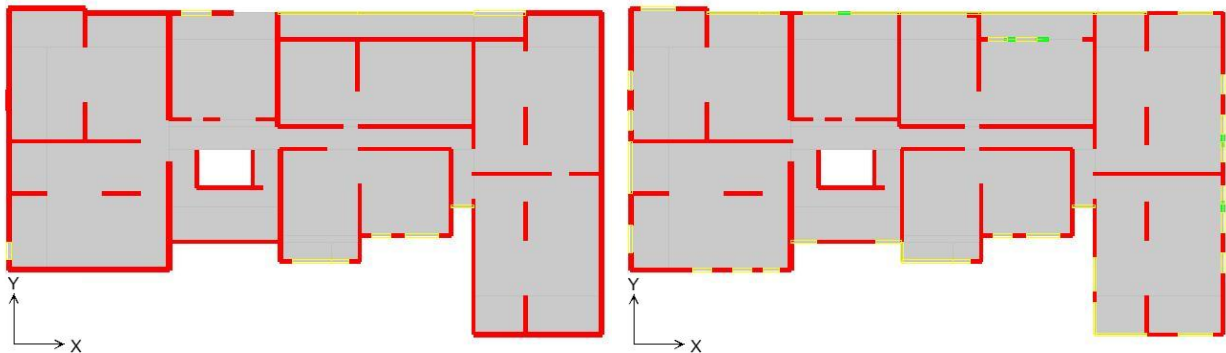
Planta primer piso (izquierda) y piso tipo (derecha) edificio H2
